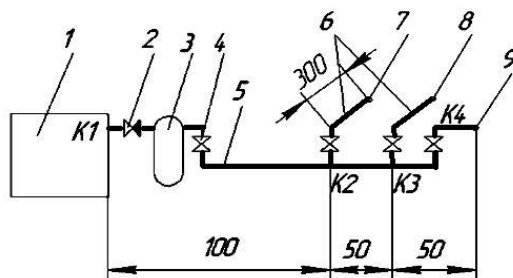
Розрахункова схема мережі стисненого повітря: 1 – компресорна станція; 2 – зворотний клапан; 3 – ресивер; 4 – засувки; 5 – центральний колектор; 6 – відгалуження; 7, 8, 9 – споживачі
